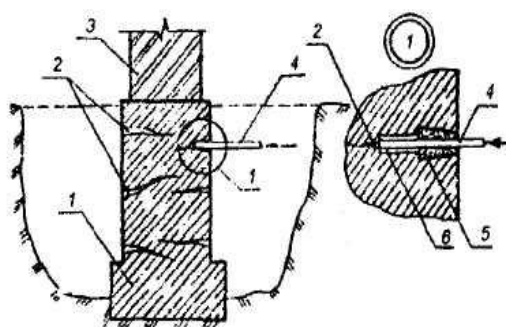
Закрепление бетонных (железобетонных) фундаментов имеющих трещины, синтетическими смолами
